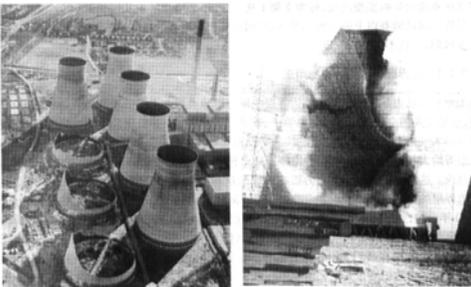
1965 年 Ferrybridge 发电厂冷却塔风毁
